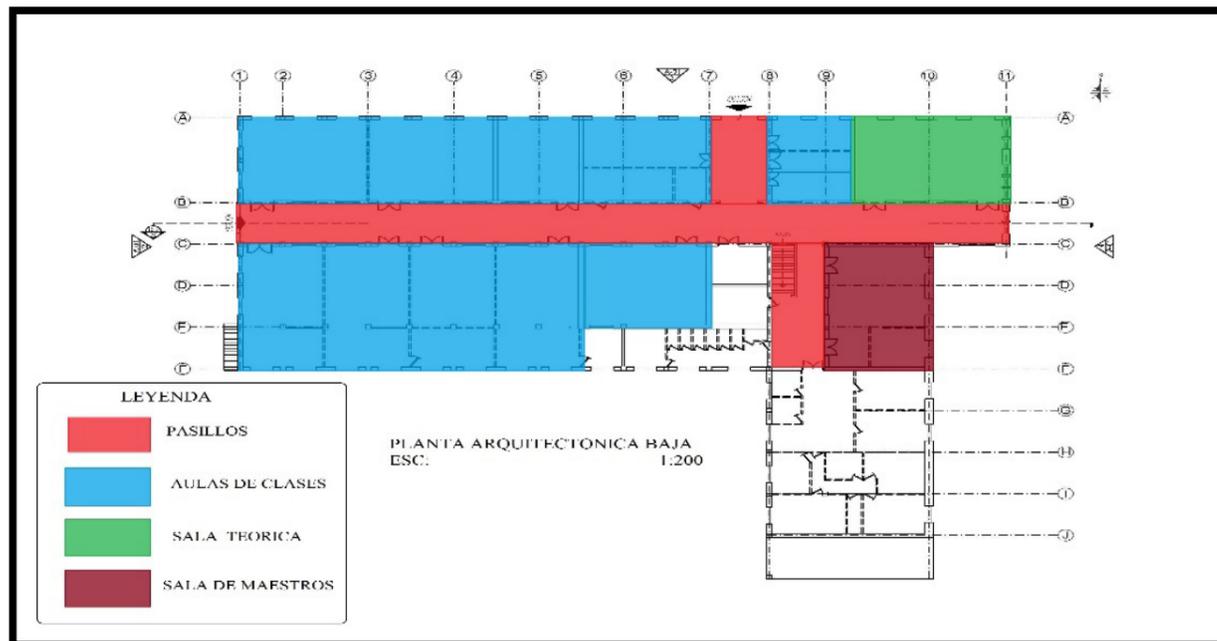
Zonificación planta baja INTECNA Fuente: Autores
